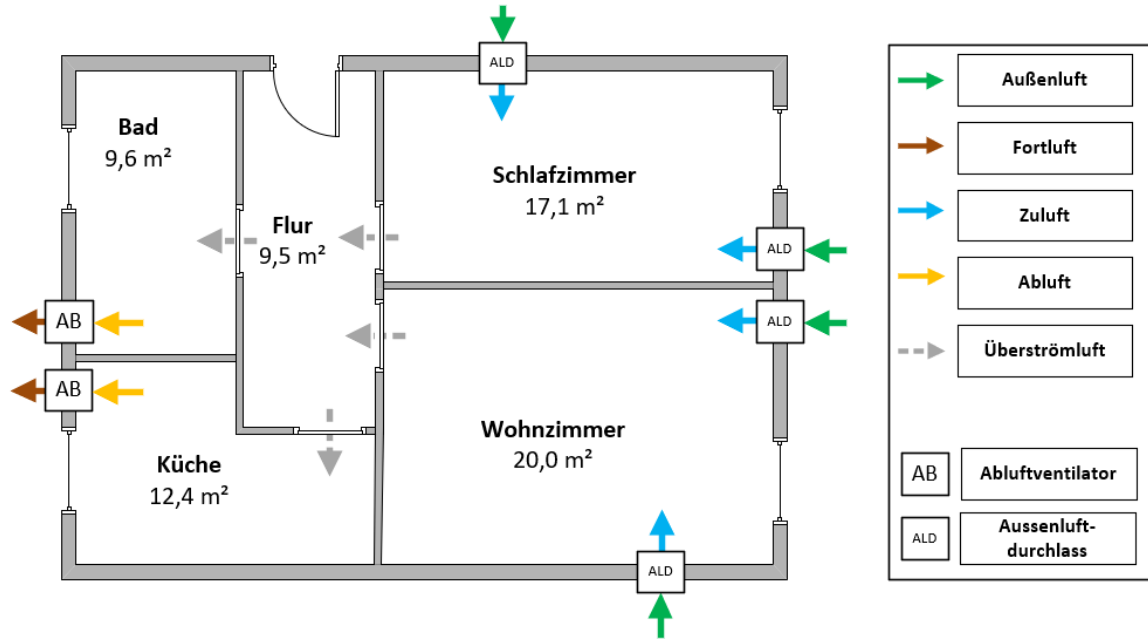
Grundriss Zwei-Zimmer-Wohnung, schematische Darstellung Abluft-Lüftungssystem
